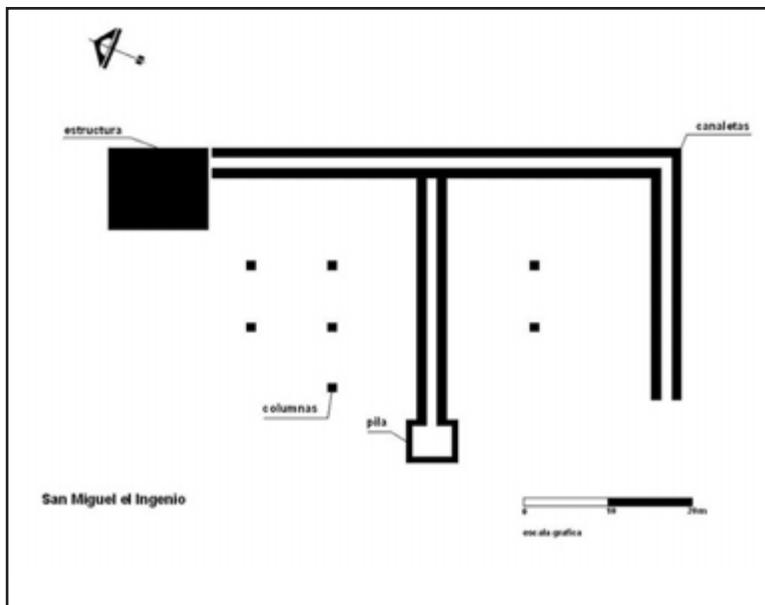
Vista de planta de los restos del Ingenio San Miguel, Meztapán, Santa Ana.
